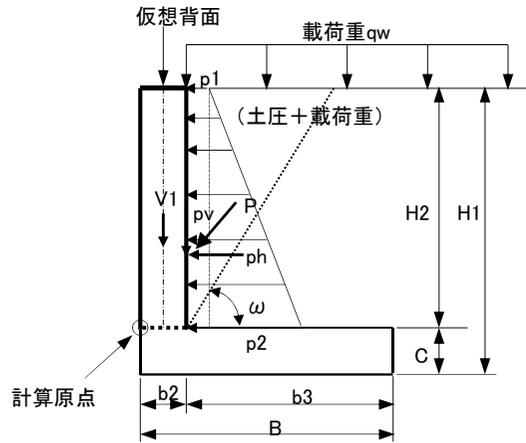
片持ち梁式擁壁の部材設計の照査位置
